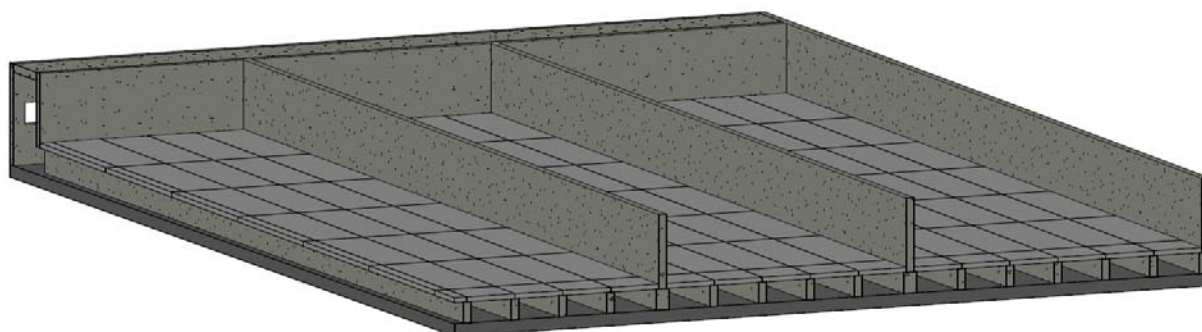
SCHEMA TIPICO STRUTTURA BIOFILTRO
